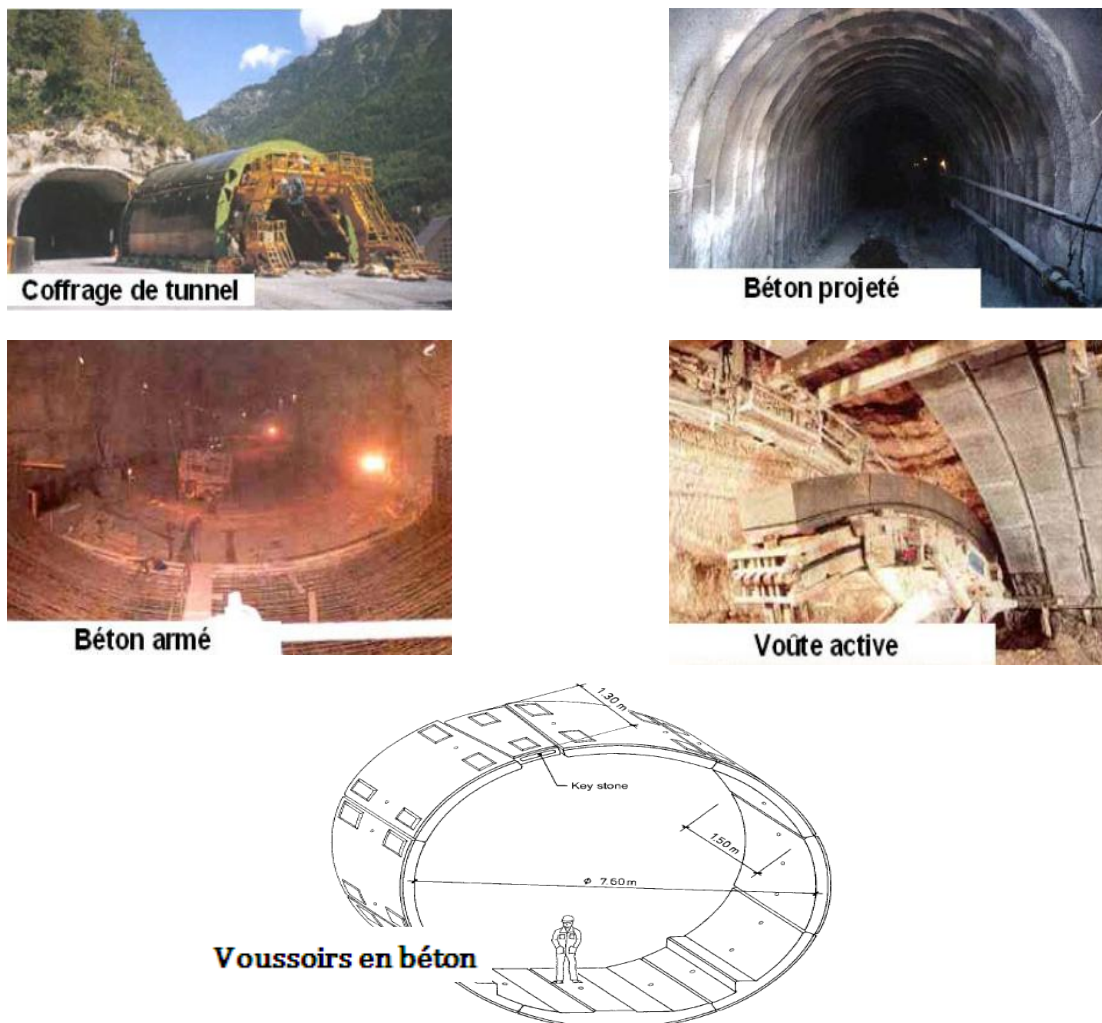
Types de soutènement et de revêtement des tunnels.
